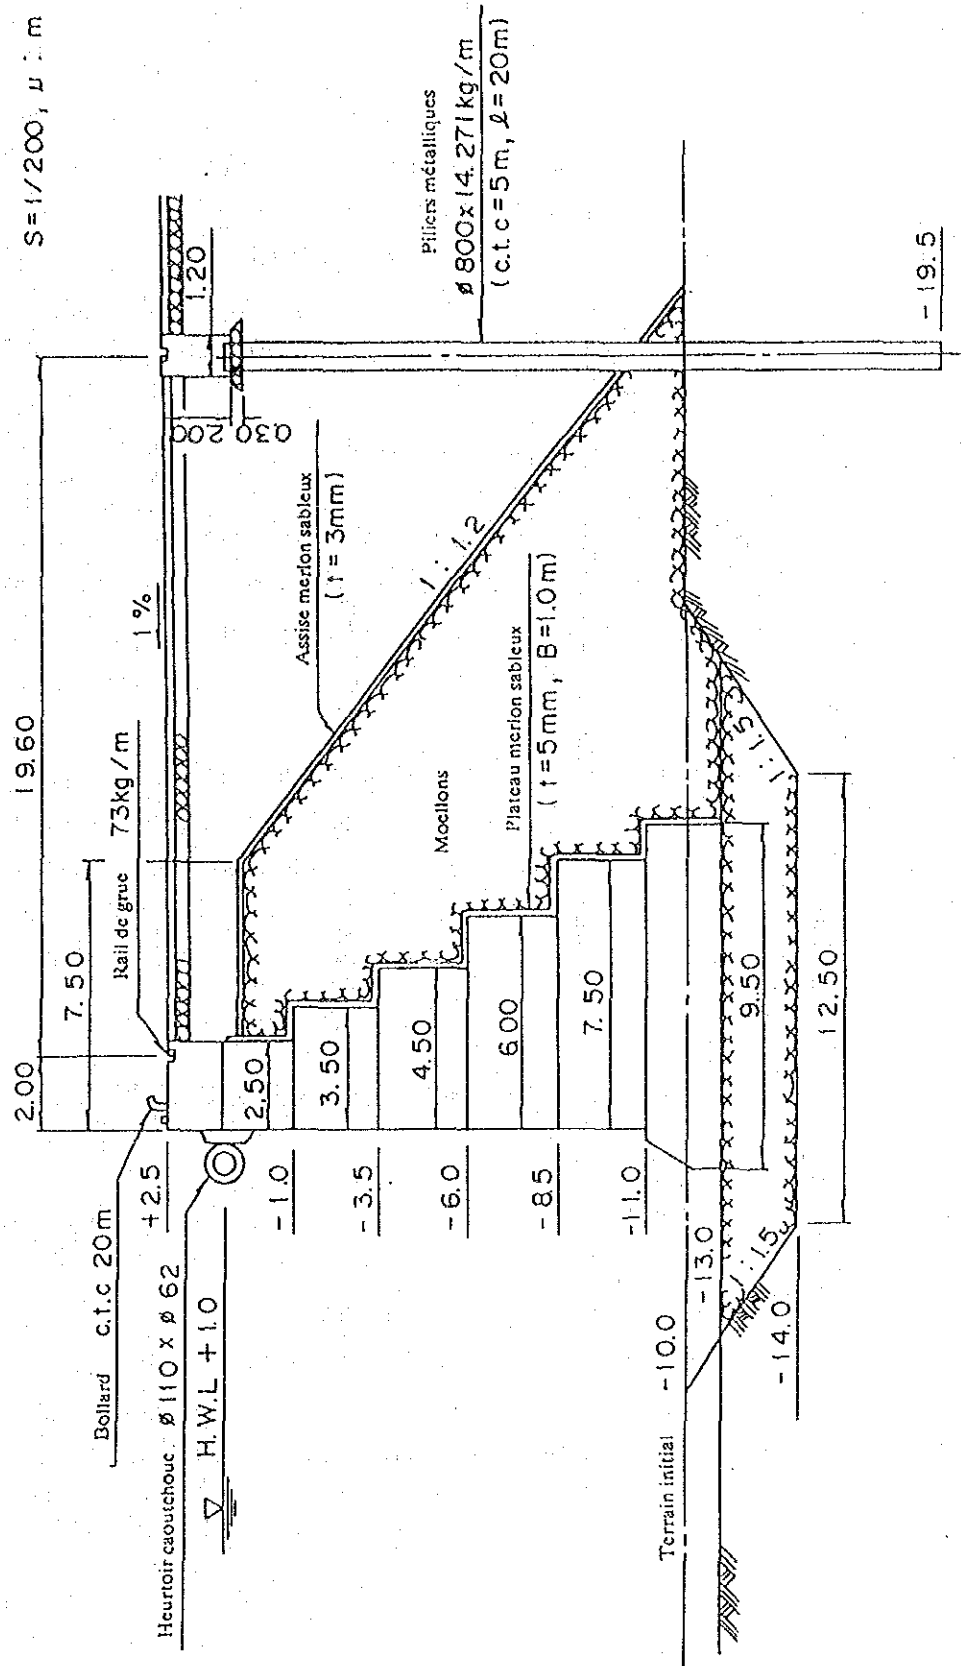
Section typique d'un quai en blocs de béton
